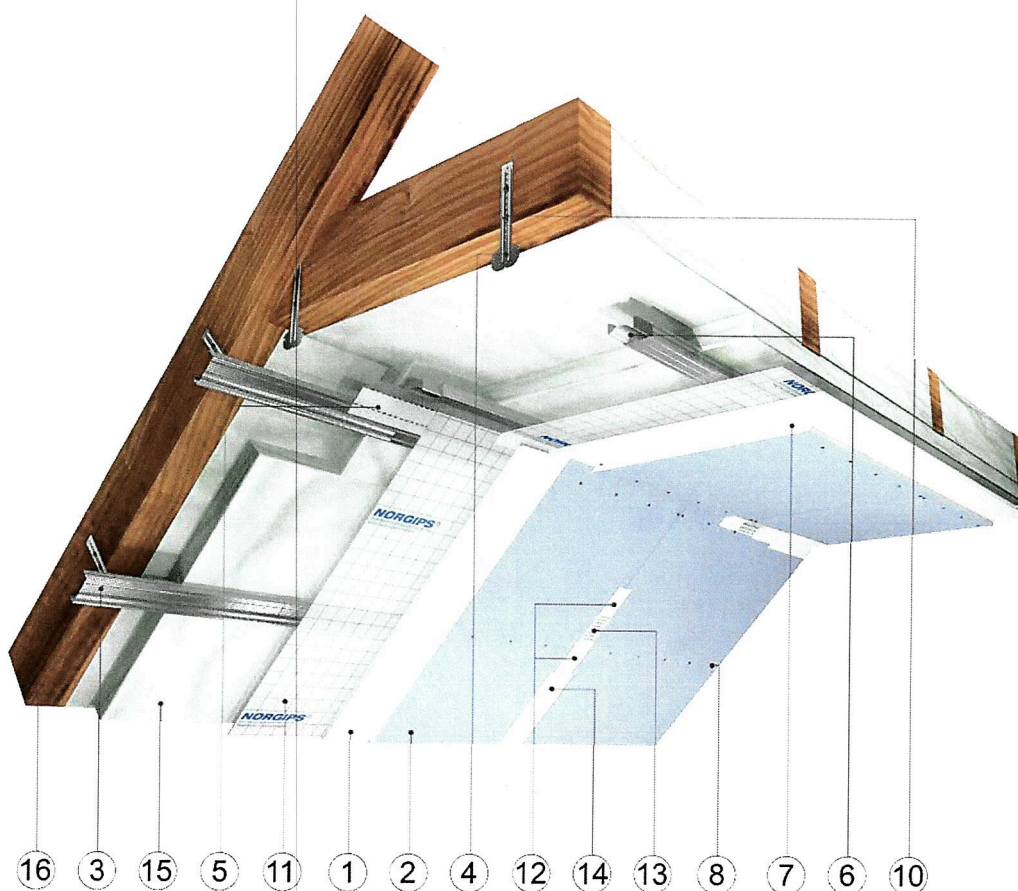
Przekrój poziomy zabudowy dachu na konstrukcji z profili kapeluszowych
